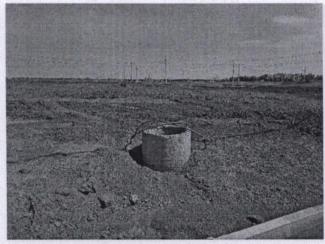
AV. LEONEL, DETALHE POÇO DE VISITA DE ESGOTO.
